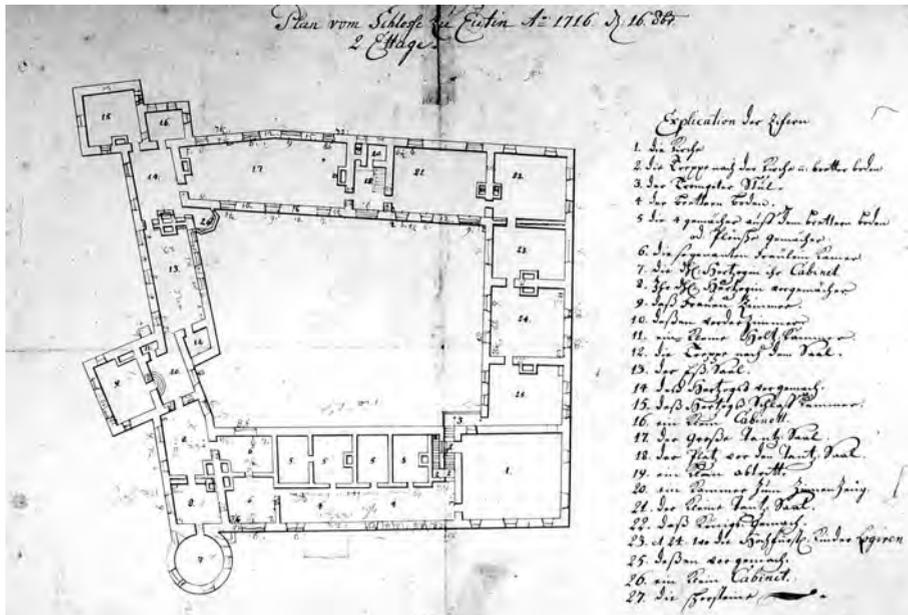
Grundriss des Eutiner Schlosses aus dem Jahr 1716. Grundriss von einem SW-Foto des Landesamtes für Denkmalpflege Kiel aus dem Schlossarchiv Eutin.
